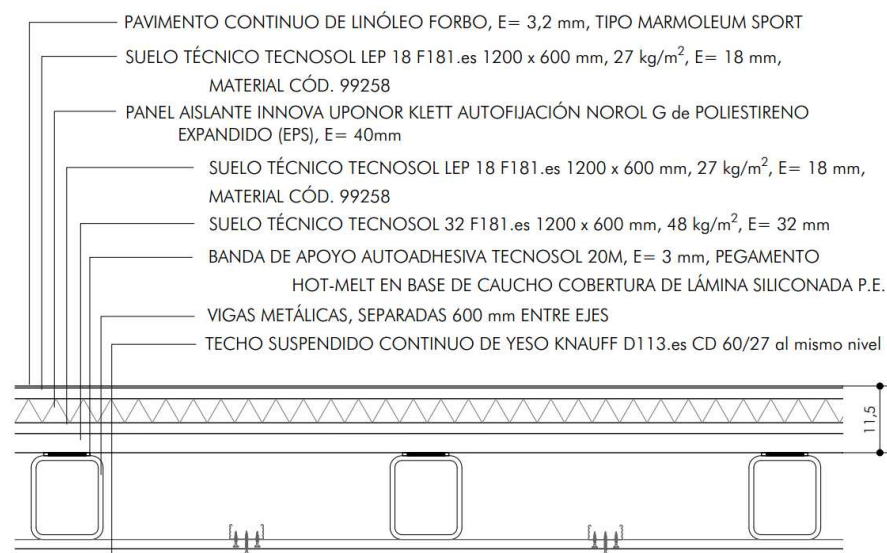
Sección constructiva de la entreplanta de la cochera
